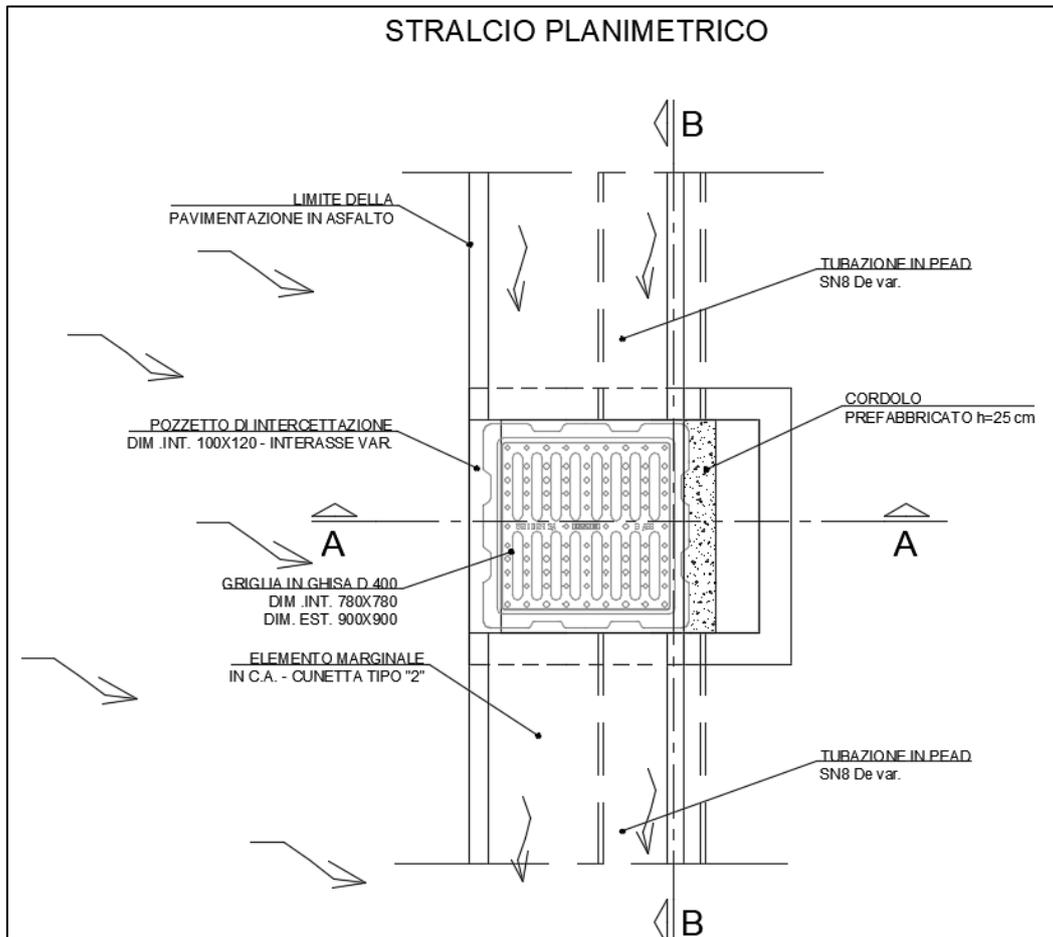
Sistema di scarico in scavo – stralcio planimetrico
